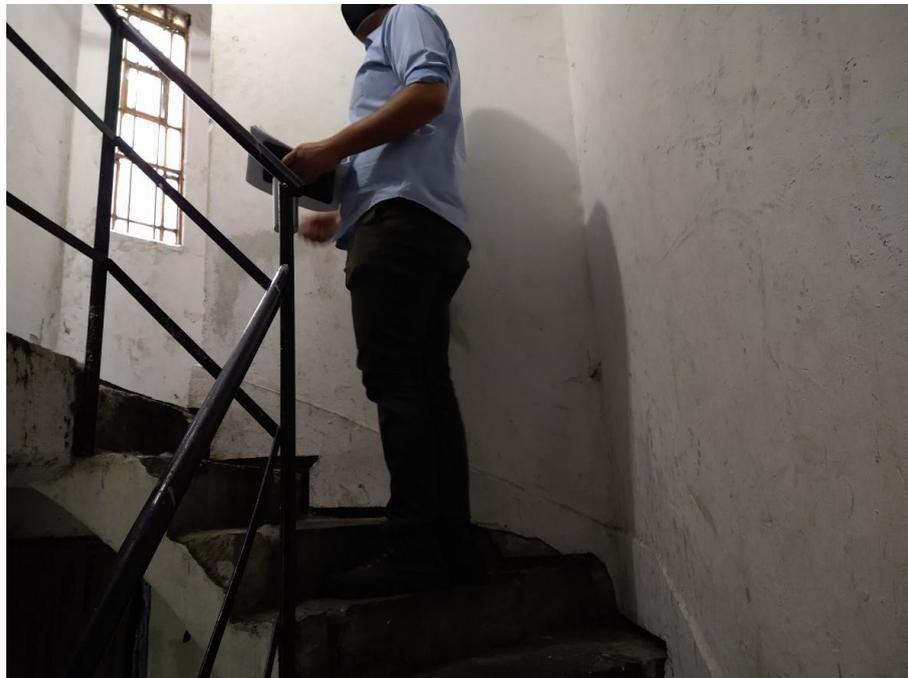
guarda corpo metálico instalado entre o segundo e quinto pavimento. Imagem extraída do relatório do COMDEC de 2021
